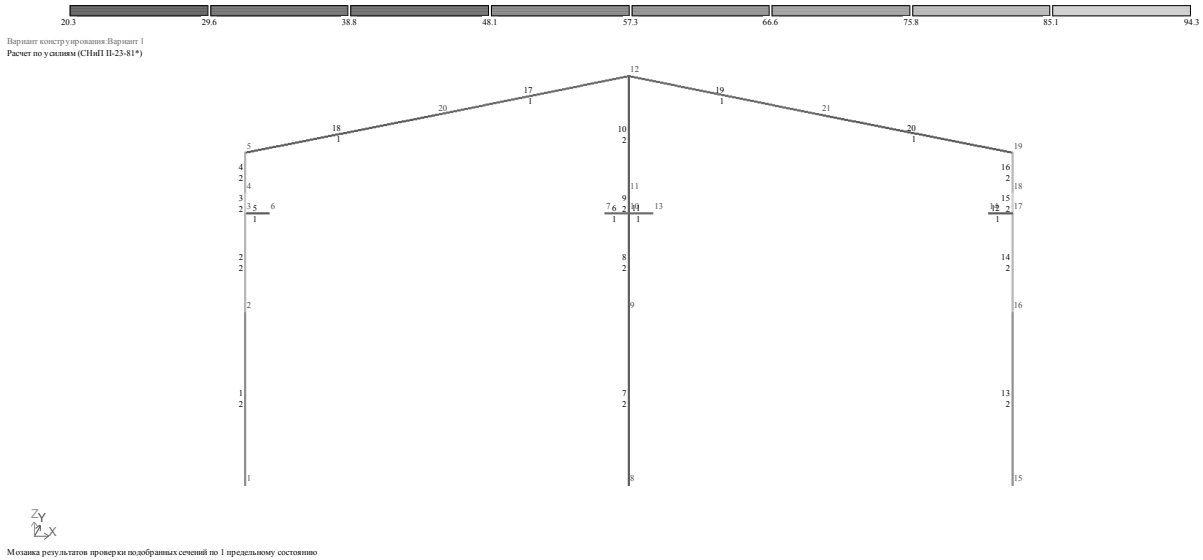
Первое предельное состояние конструкций. Проверка подобранных сечений элементов. Расчет по РСУ
